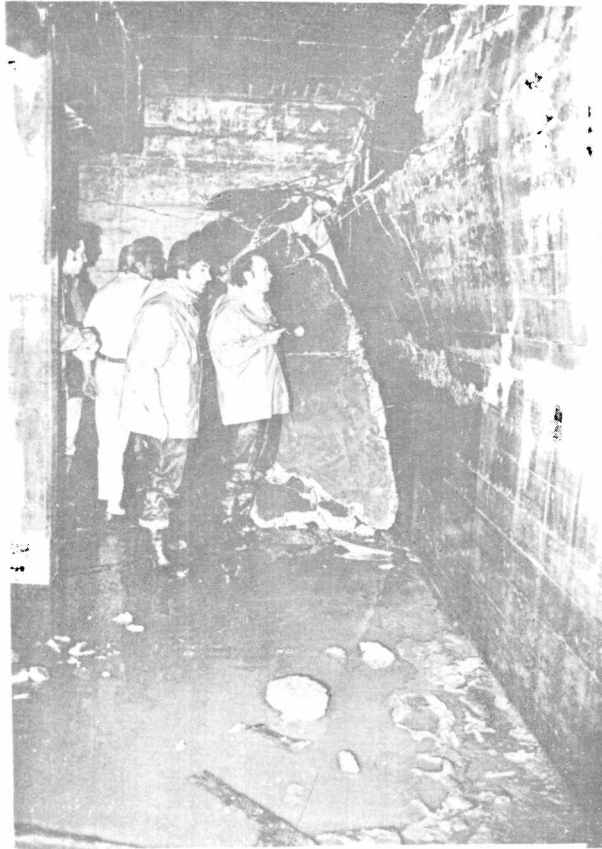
Colapso de estructura de hormigón armado. Corrosión de armaduras.
